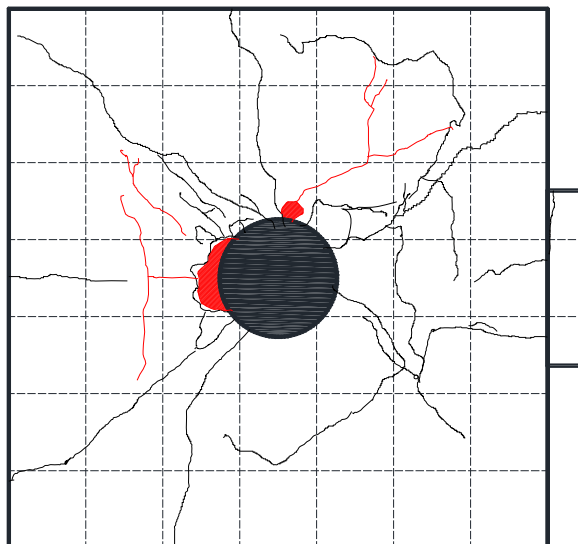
2. 3-103 パイルキャップ底面ひび割れ幅測定位置 (試験体 DR-4 -7.0 サイクル)
